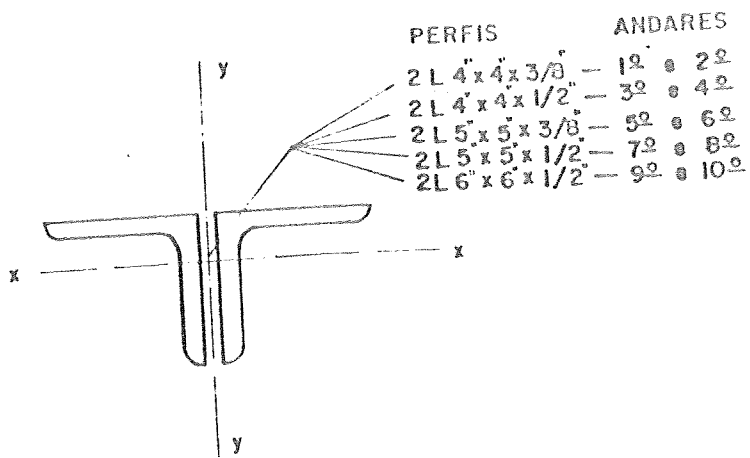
Tipos de perfis usados nas barras diagonais das estruturas do grupo 1.
